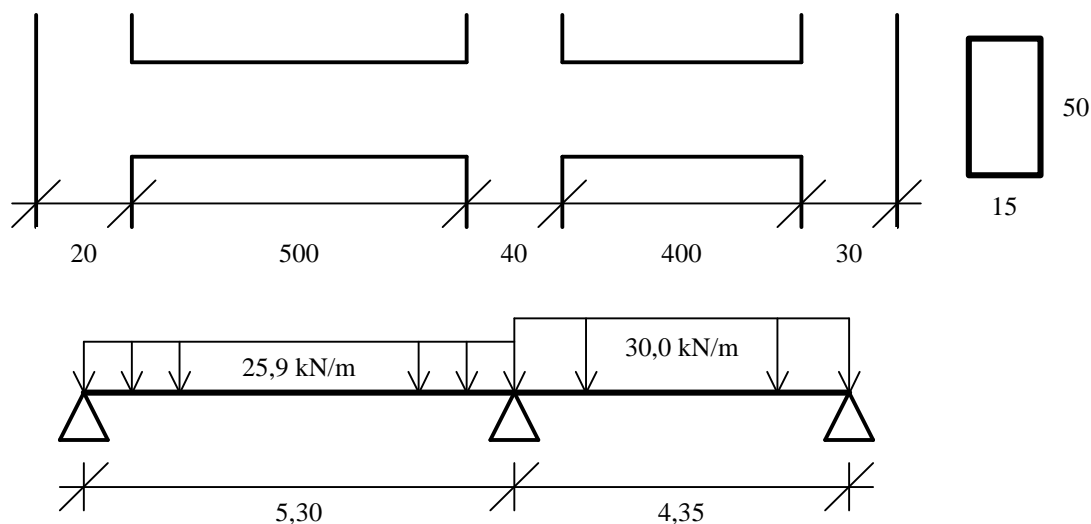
Dimensões e Carregamentos da Viga do Exemplo 3.
